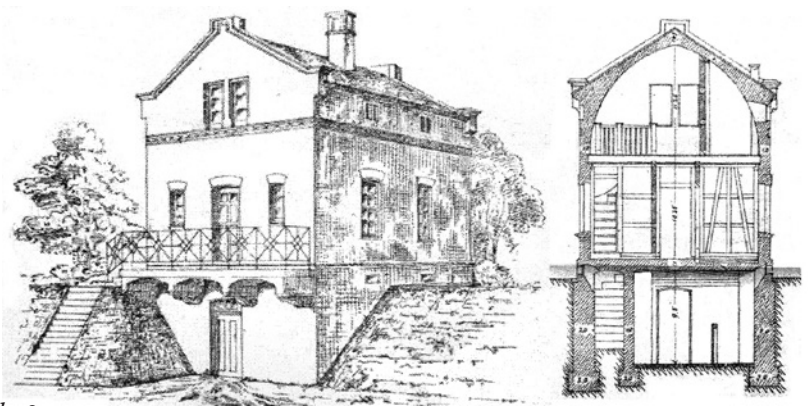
Aus Romanzement in Stampfbetontechnik erbautes Bahnwärterhaus im Blautal bei Ulm. (Abb. aus Schlierholz, J. (1870): Ueber Beton-Verwendung zu Hochbauzwecken, hauptsächlich zu ganzen Gebäuden, in: Allgemeine Bauzeitung Wien 1870, S. 260-265.
